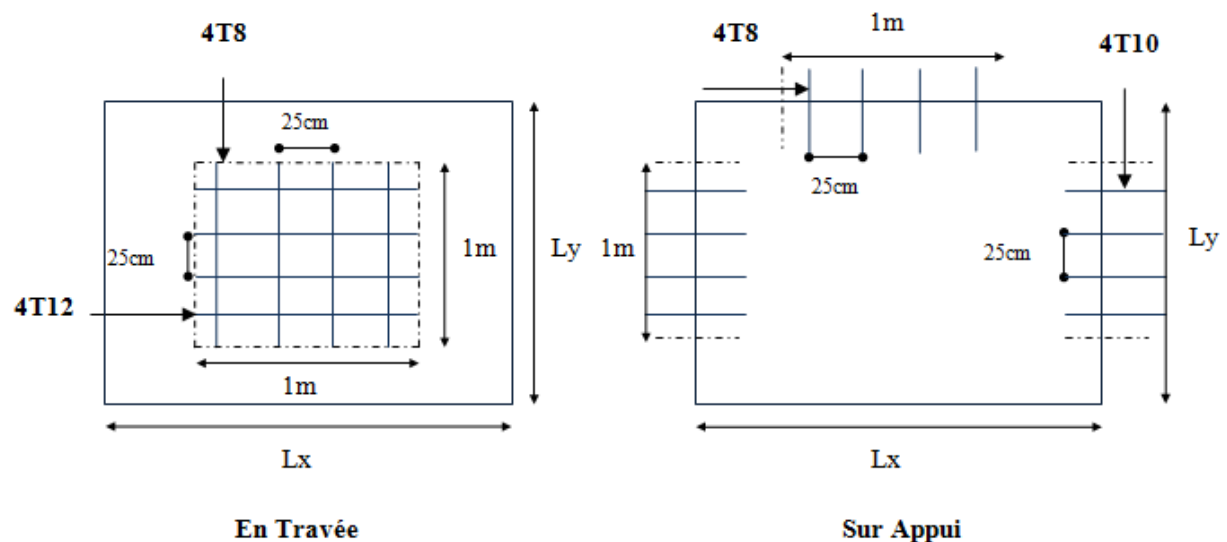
Ferrailage de plancher de Sous-Sol 1 et 2.
